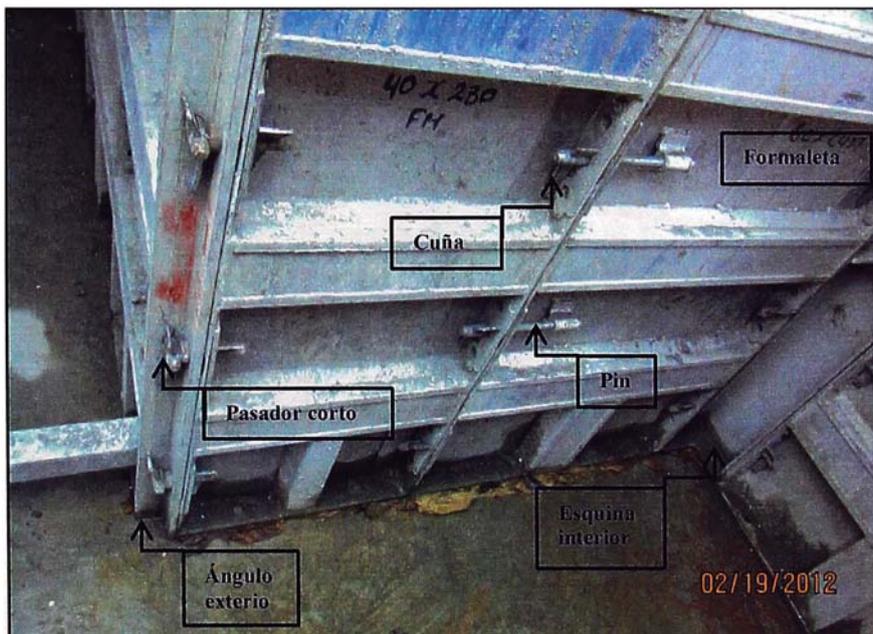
Encofrado de esquina de muro - FORSA.
